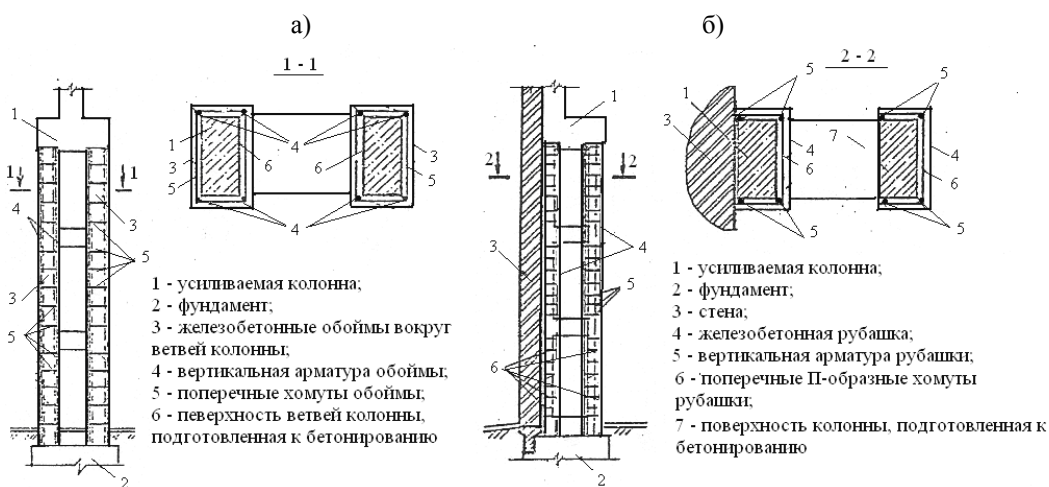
Усиление железобетонных двухветвевых средних колонн железобетонной обоймой (а) и крайних колонн – железобетонной рубашкой (б)
